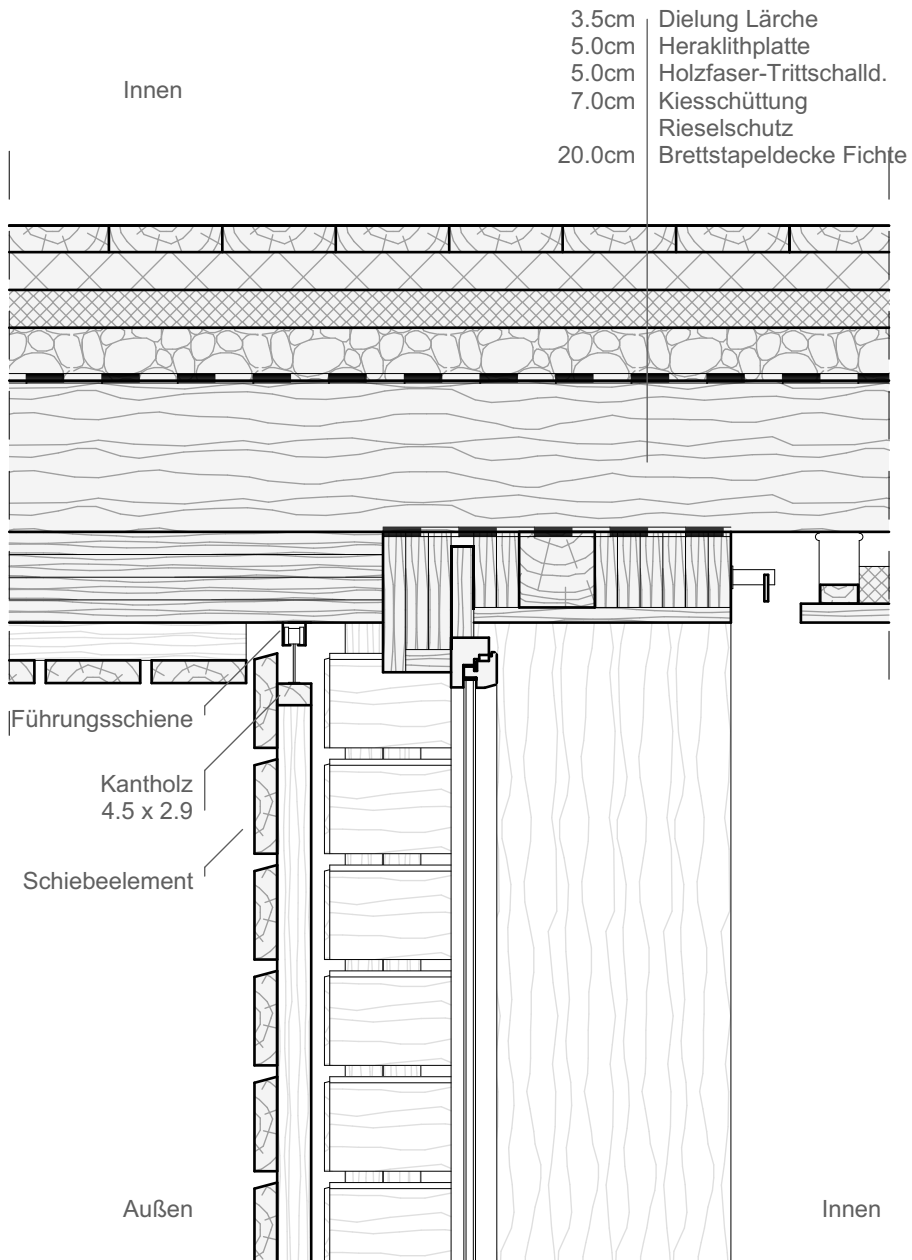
Balkon - Detail 2 M 1:10
